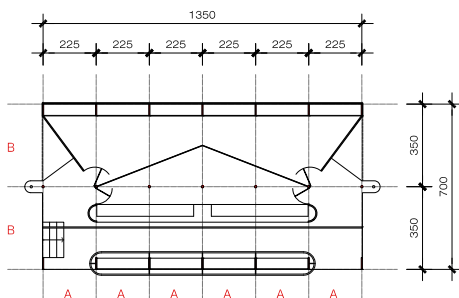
Modulação Estrutural Pavilhão Nestlé.
